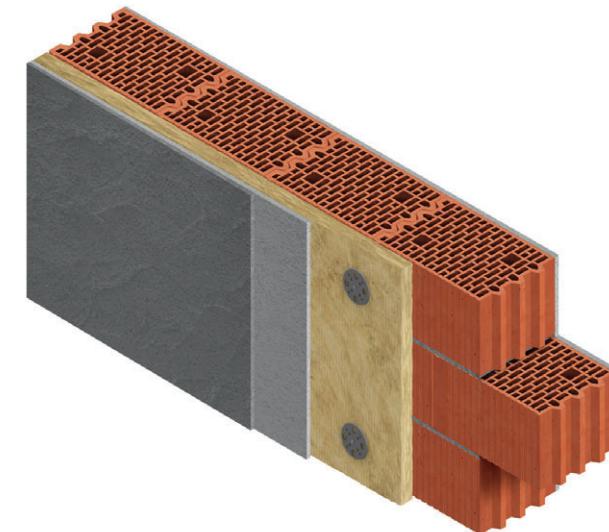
Конструкция стены из блоков Porotherm 25, минераловатных плит и штукатурки
